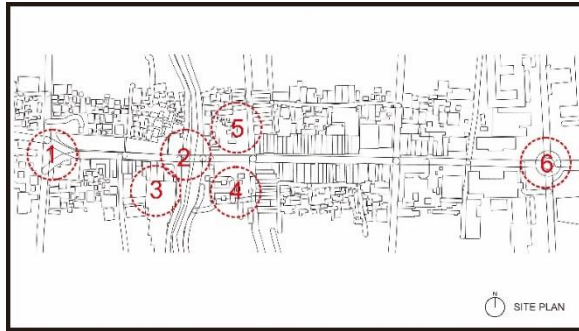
5 Site Plan Koridor Gajah Mada Denpasar
